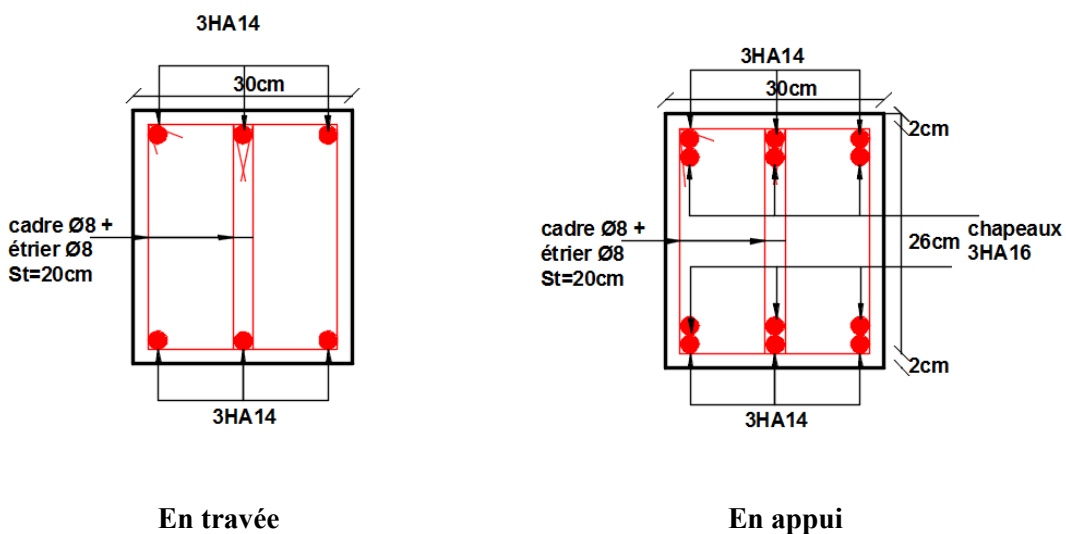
Schéma de ferrailage des Poutres Secondaires étages courants
